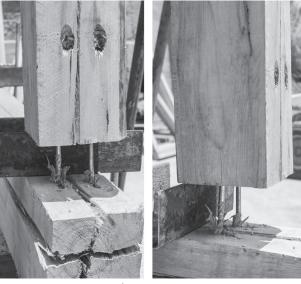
FALLA EN UNIÓN C DE PRISMA T1, FUENTE: AUTOR
